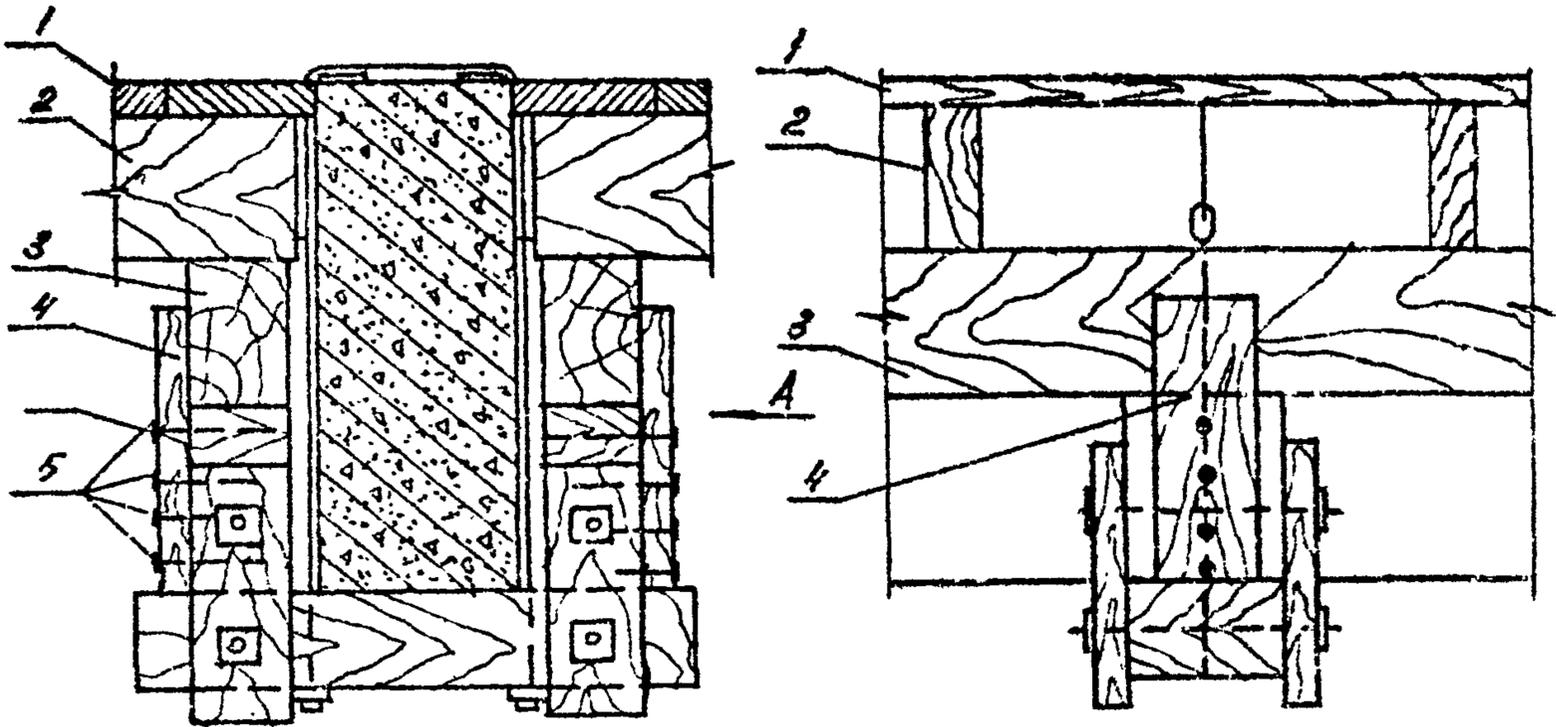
Узел "Б" Вариант по сборным железобетонным балкам перекрытия.
